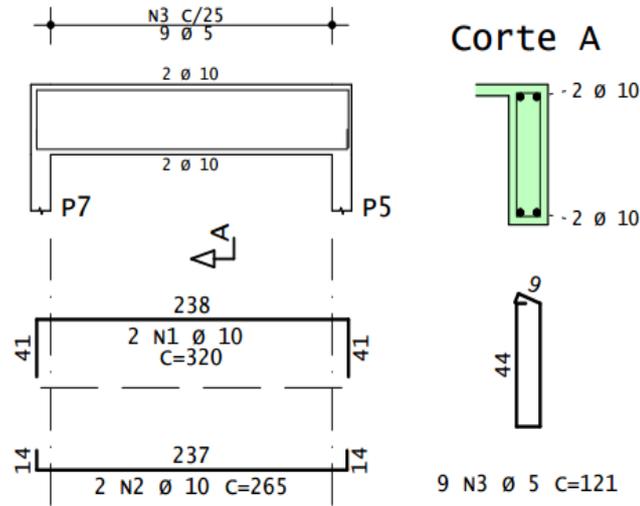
Armadura da viga V7 – coberta (nível +6,00)
